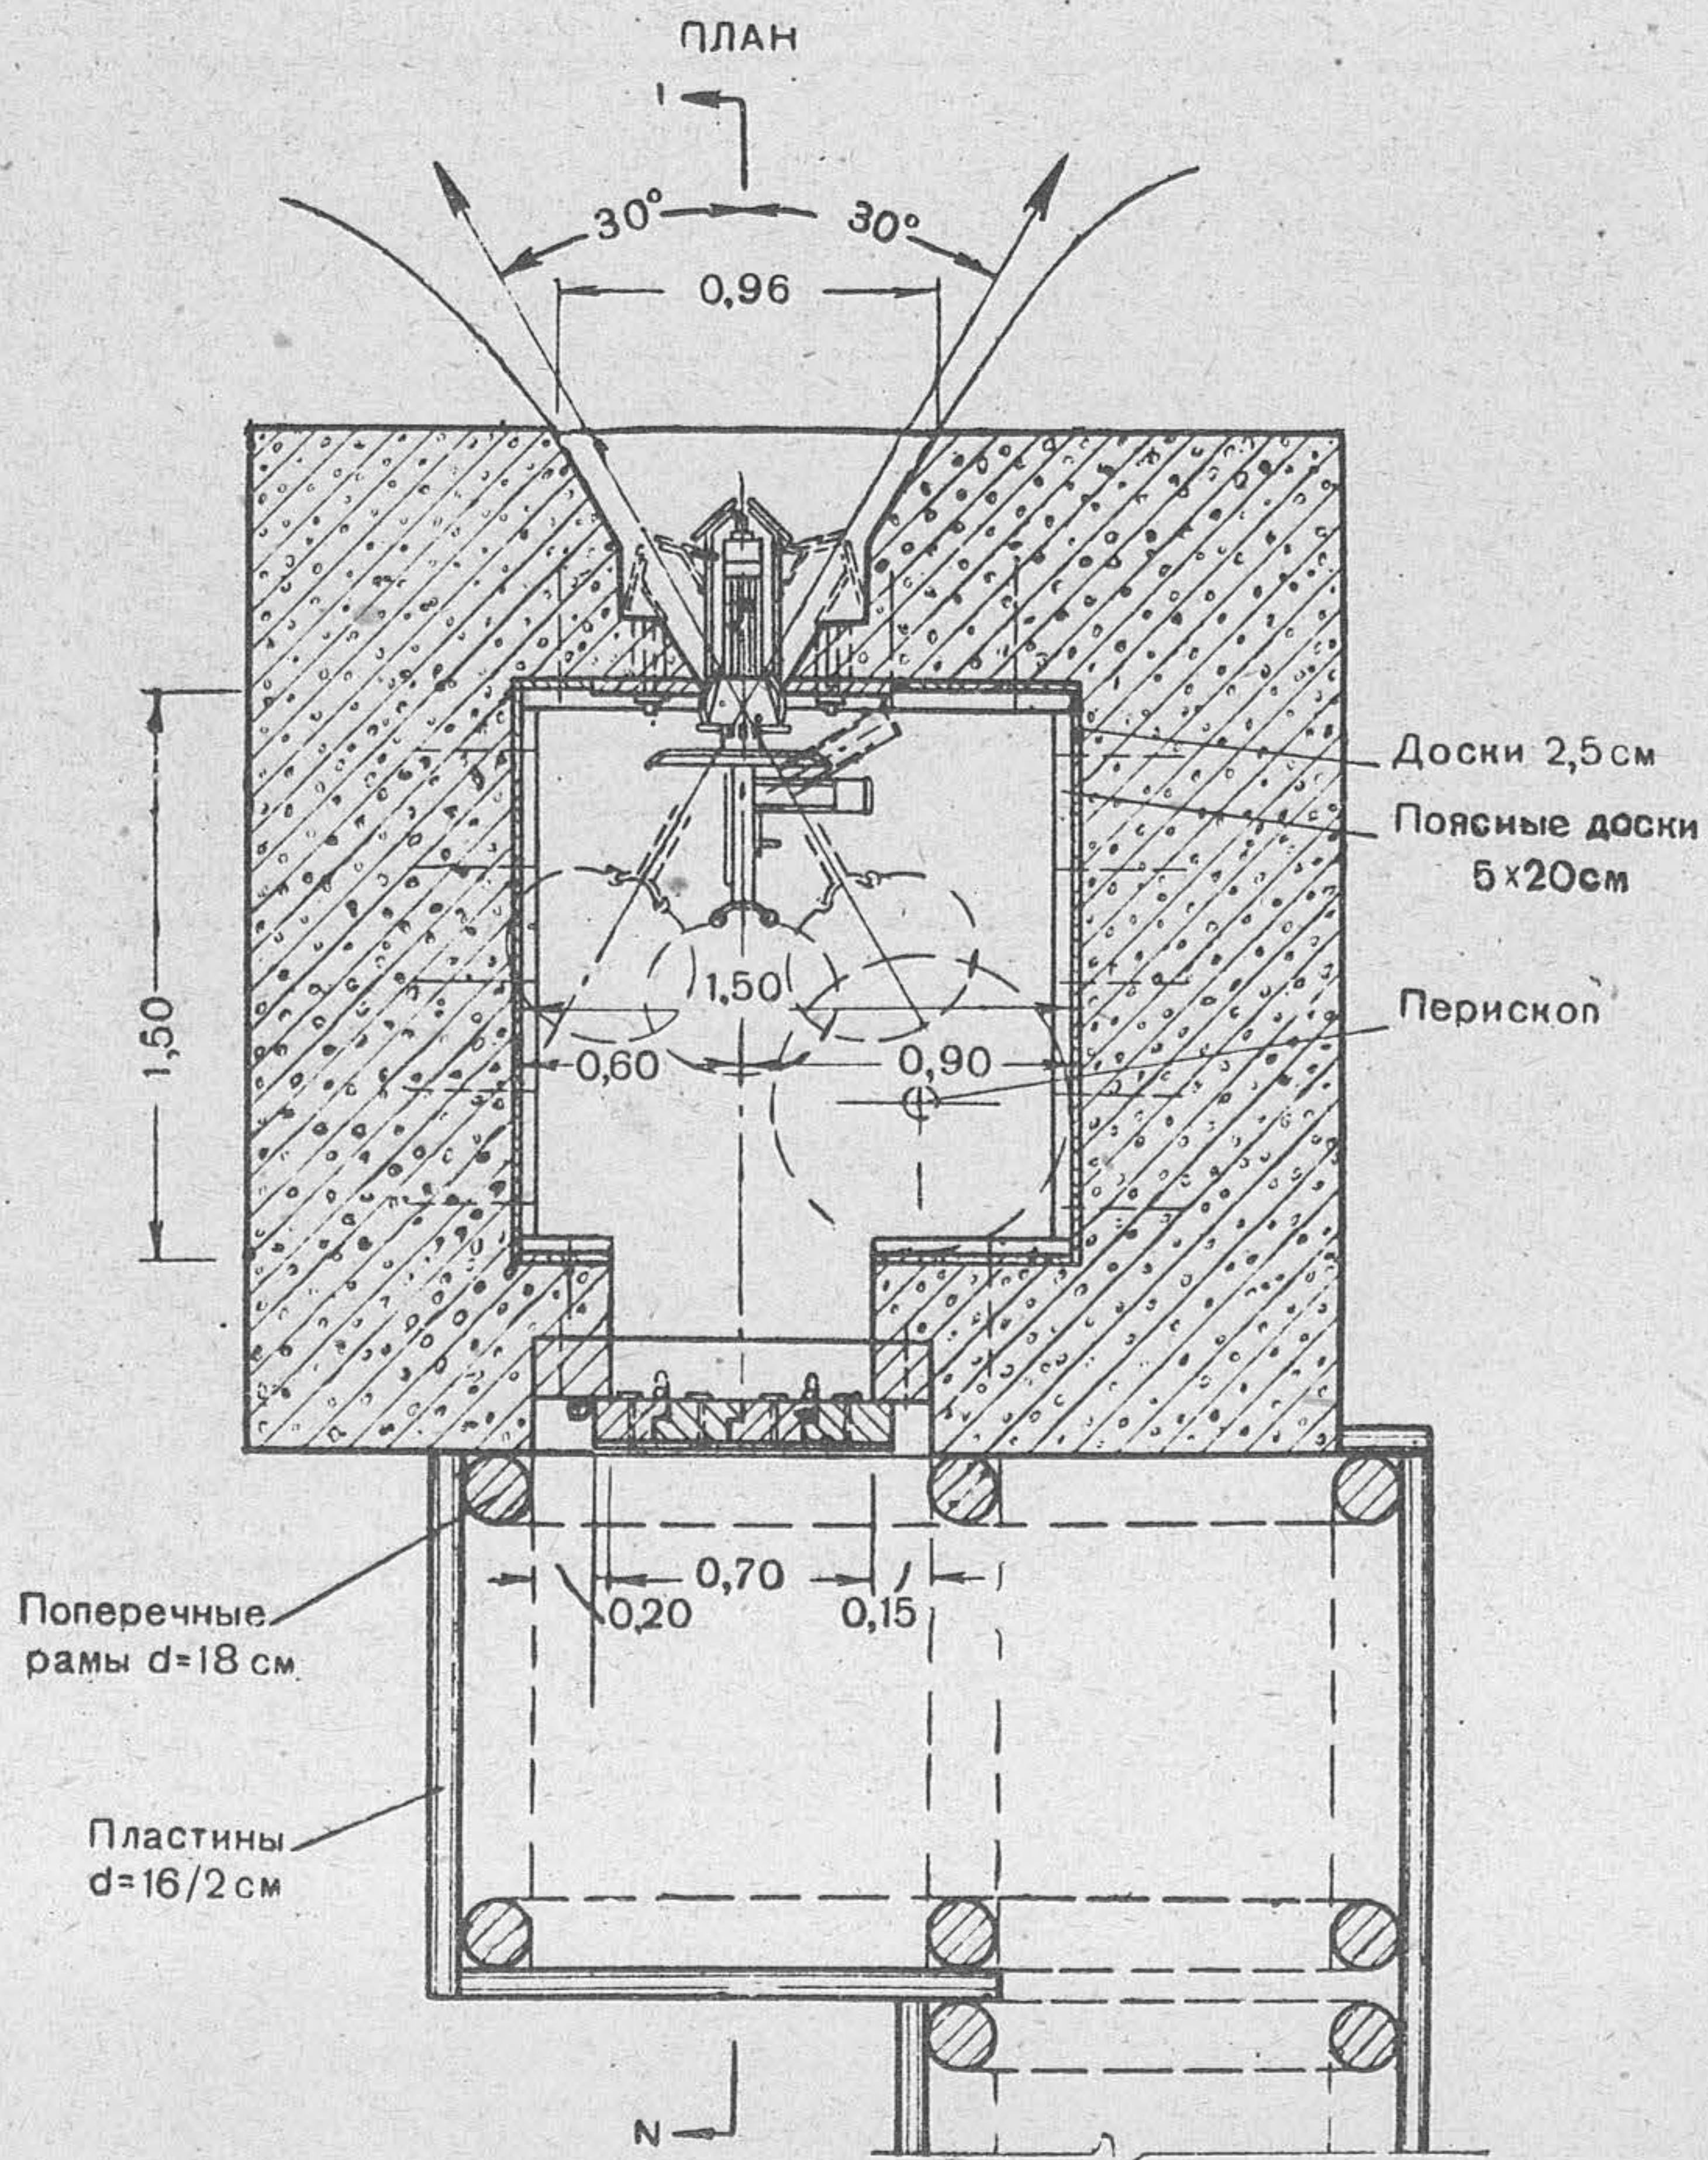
Монолитное железобетонное пулемётное сооружение фронтального действия (план)
